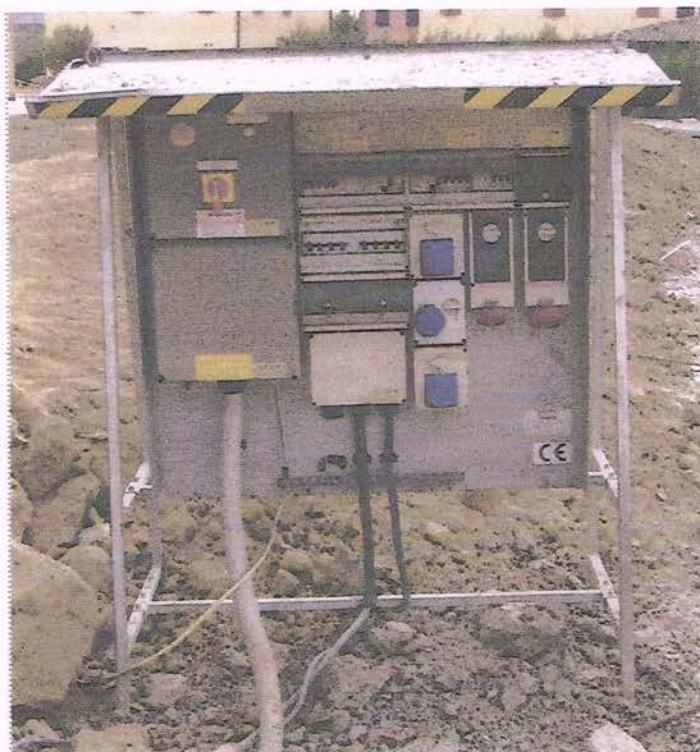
Quadro elettrico di cantiere con elementi protetti dalle intemperie.
